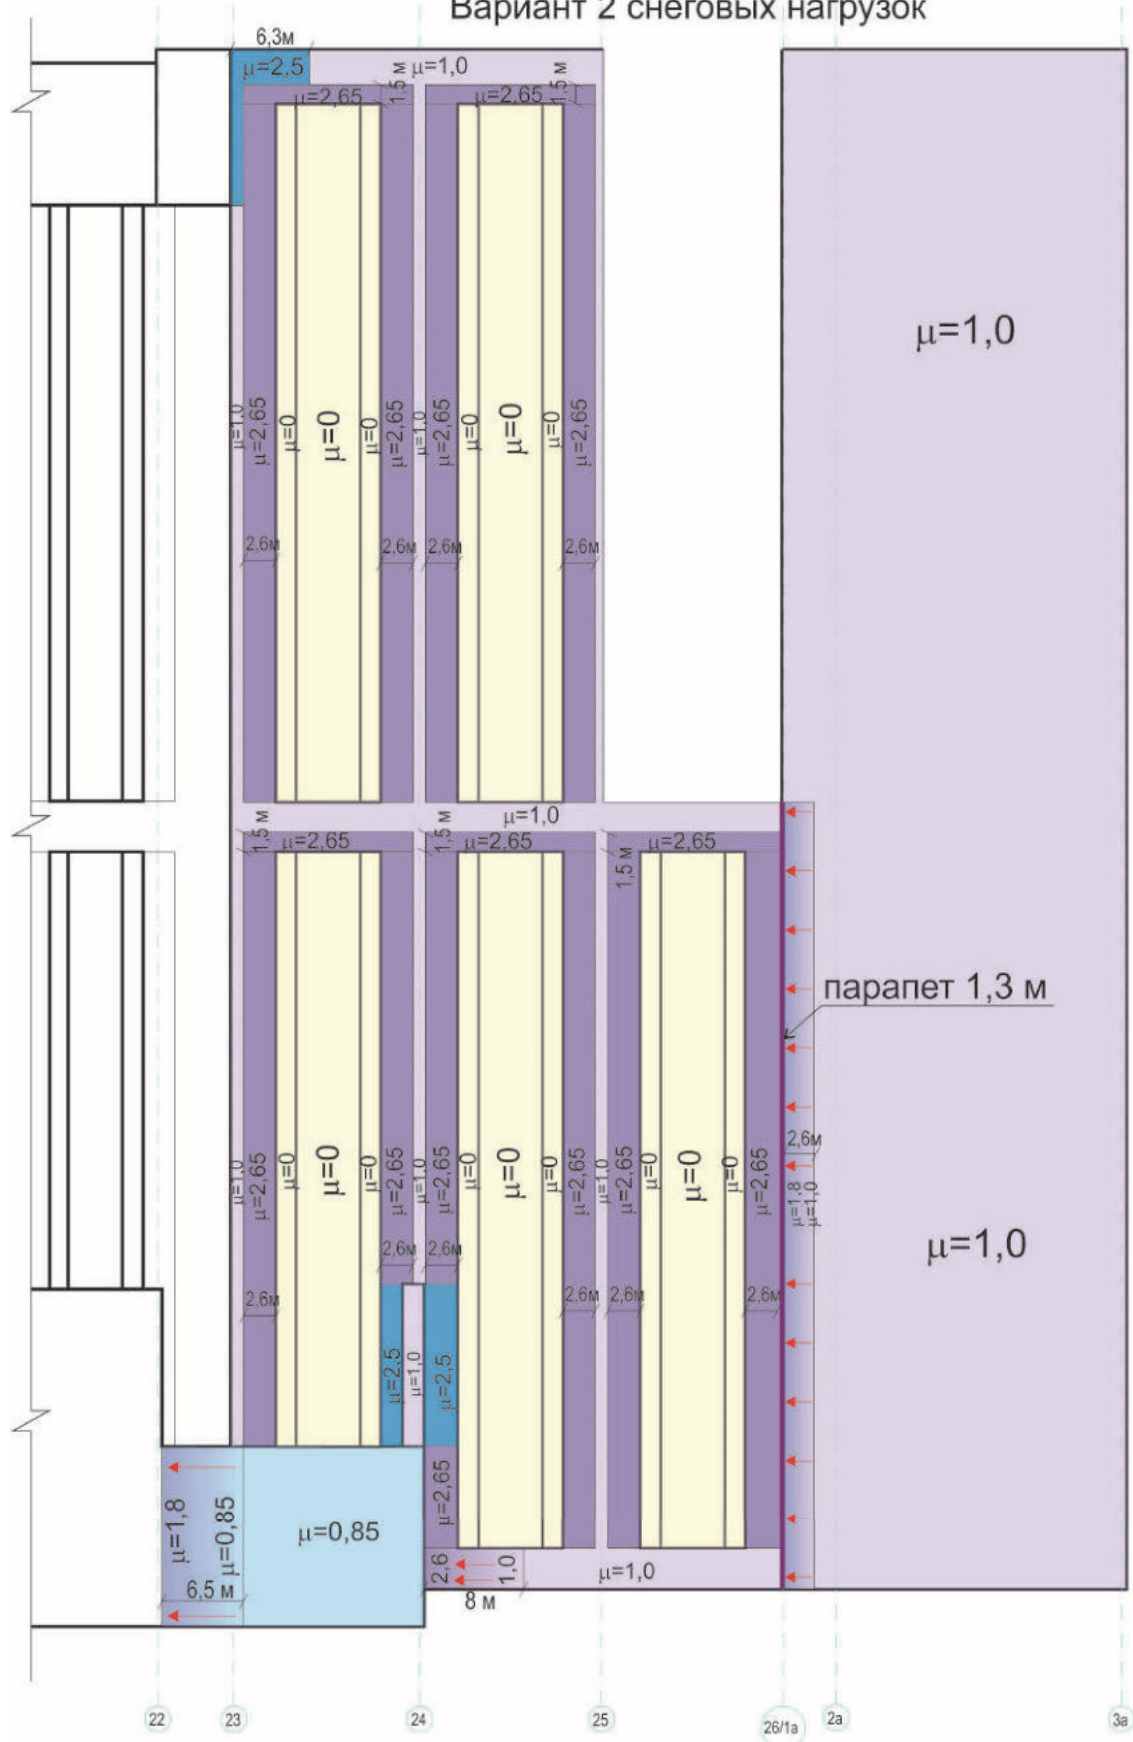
3-ий вариант покрытия. Снеговые нагрузки. Вариант 2
